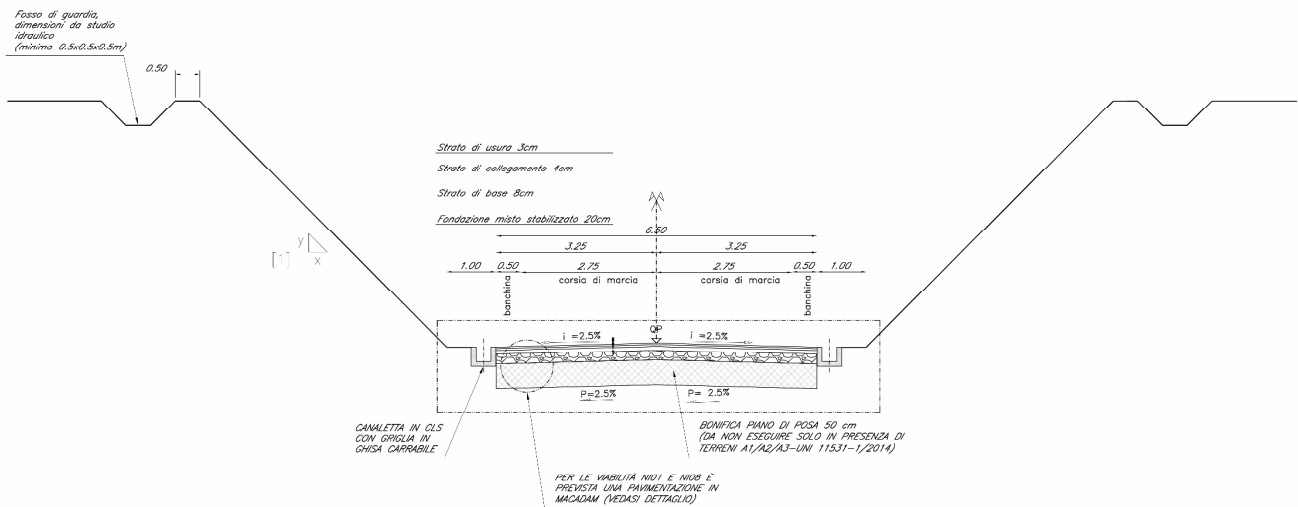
SEZIONE TIPO IN TRINCEA.
